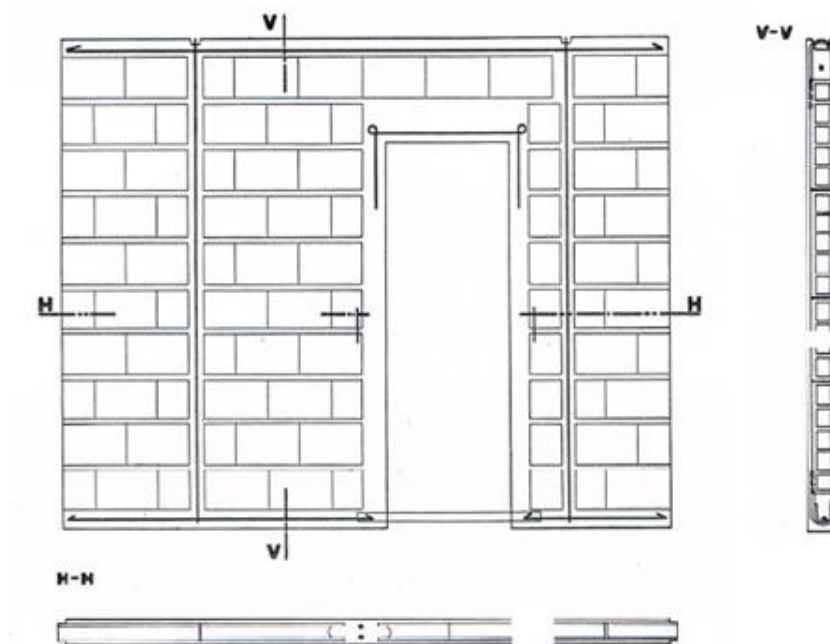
Painéis de divisórias (tabiques) (LNEC, 1968).
